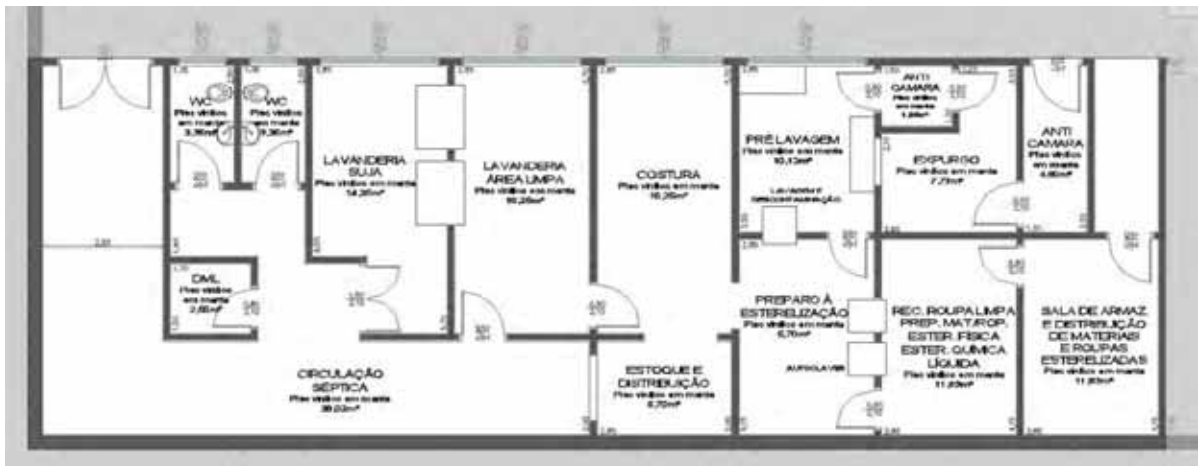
Planta do setor de processamento de roupas e da central de material esterilizado, sem escala.
